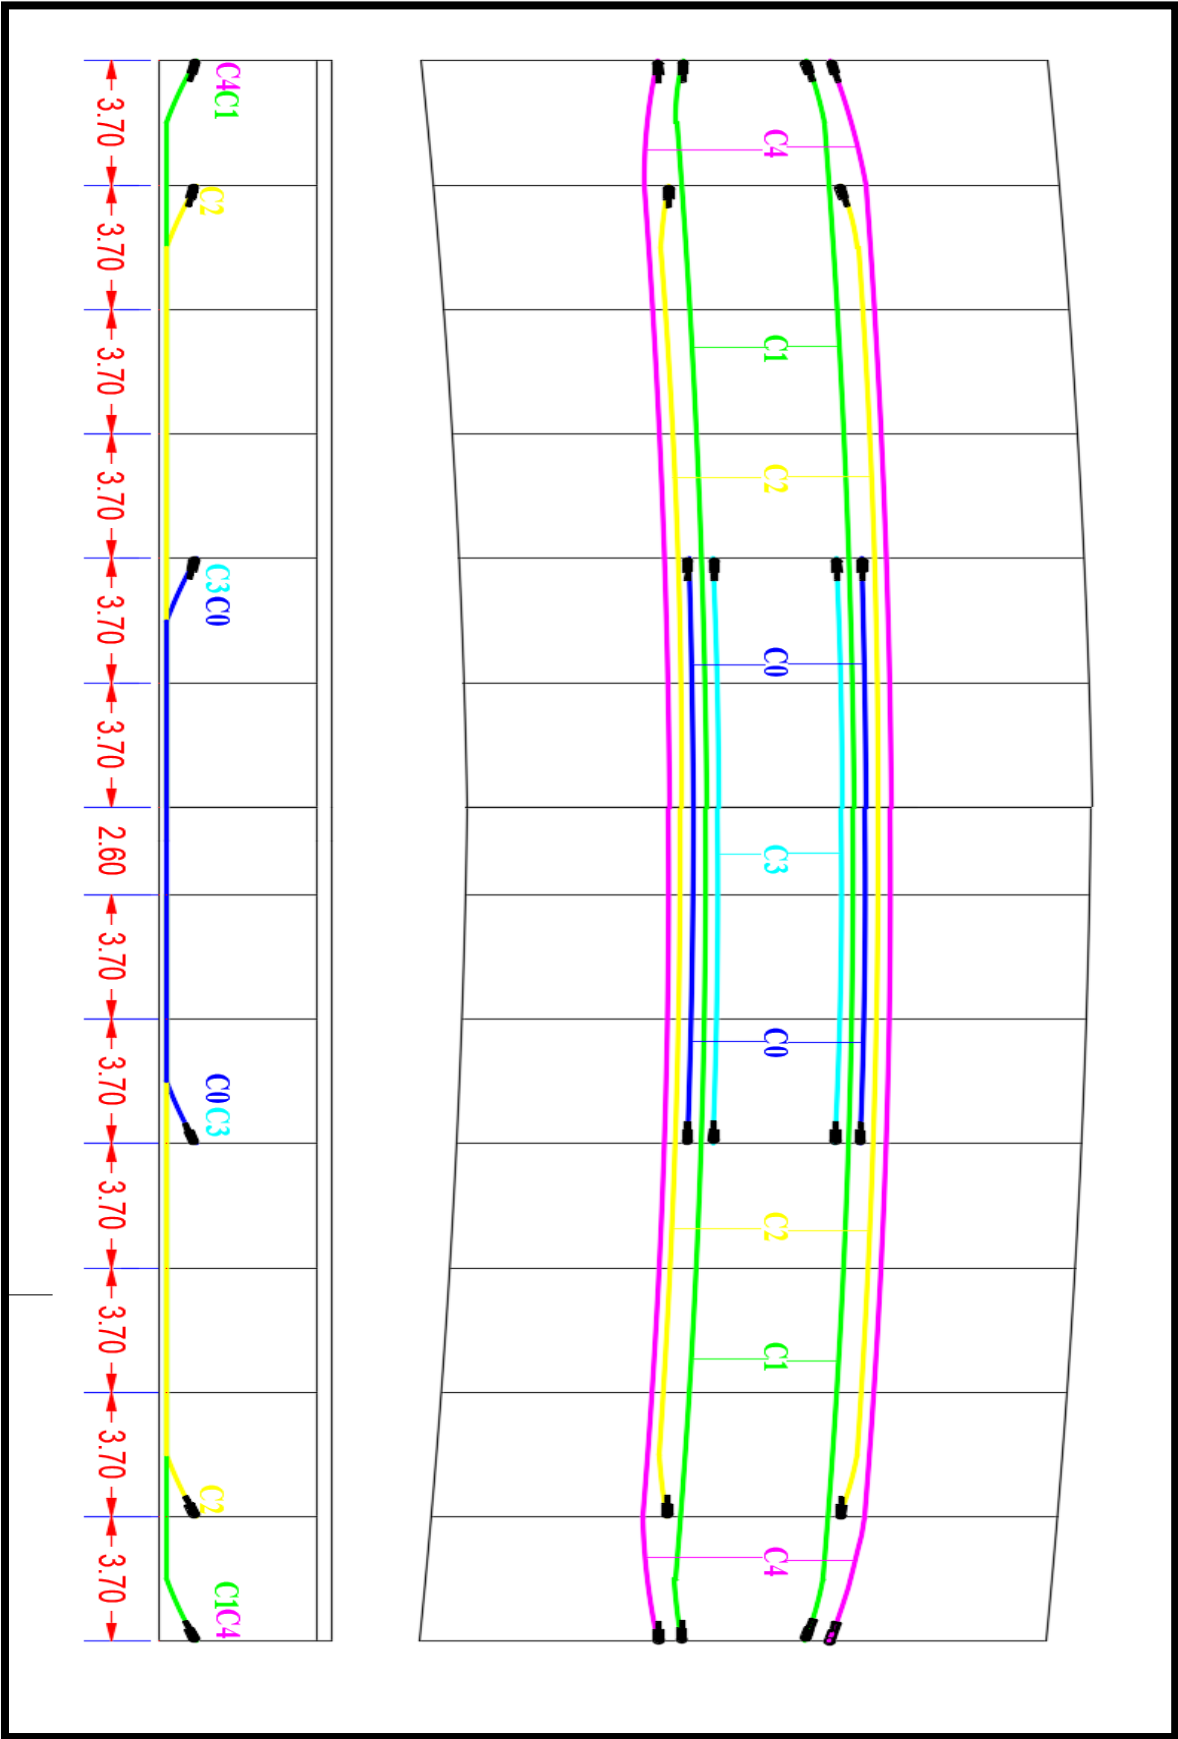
Tracée en plan et élévation des câbles de continuité de travée principale.
